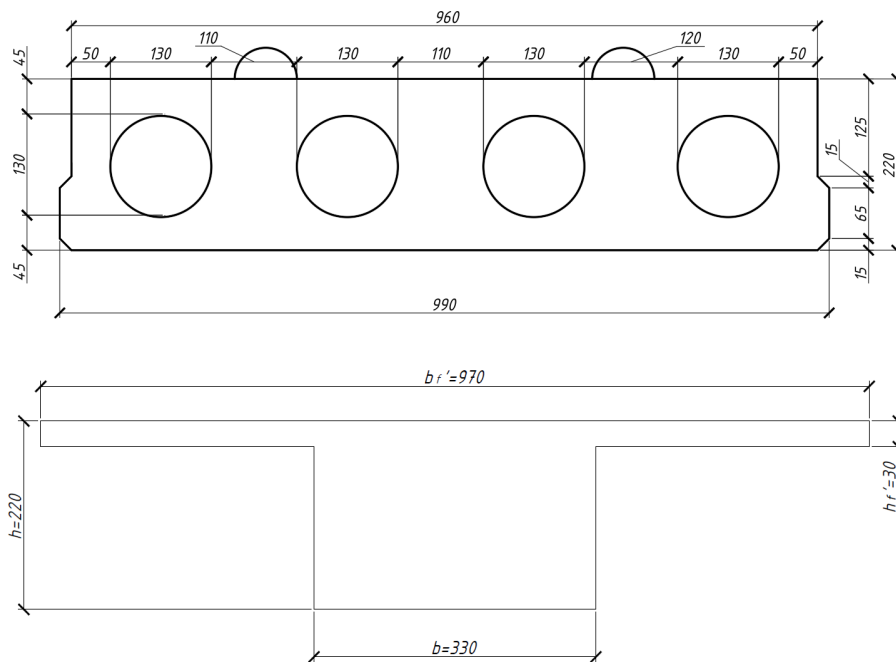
Перерізи плити перекриття розрахунковий та дійсний
